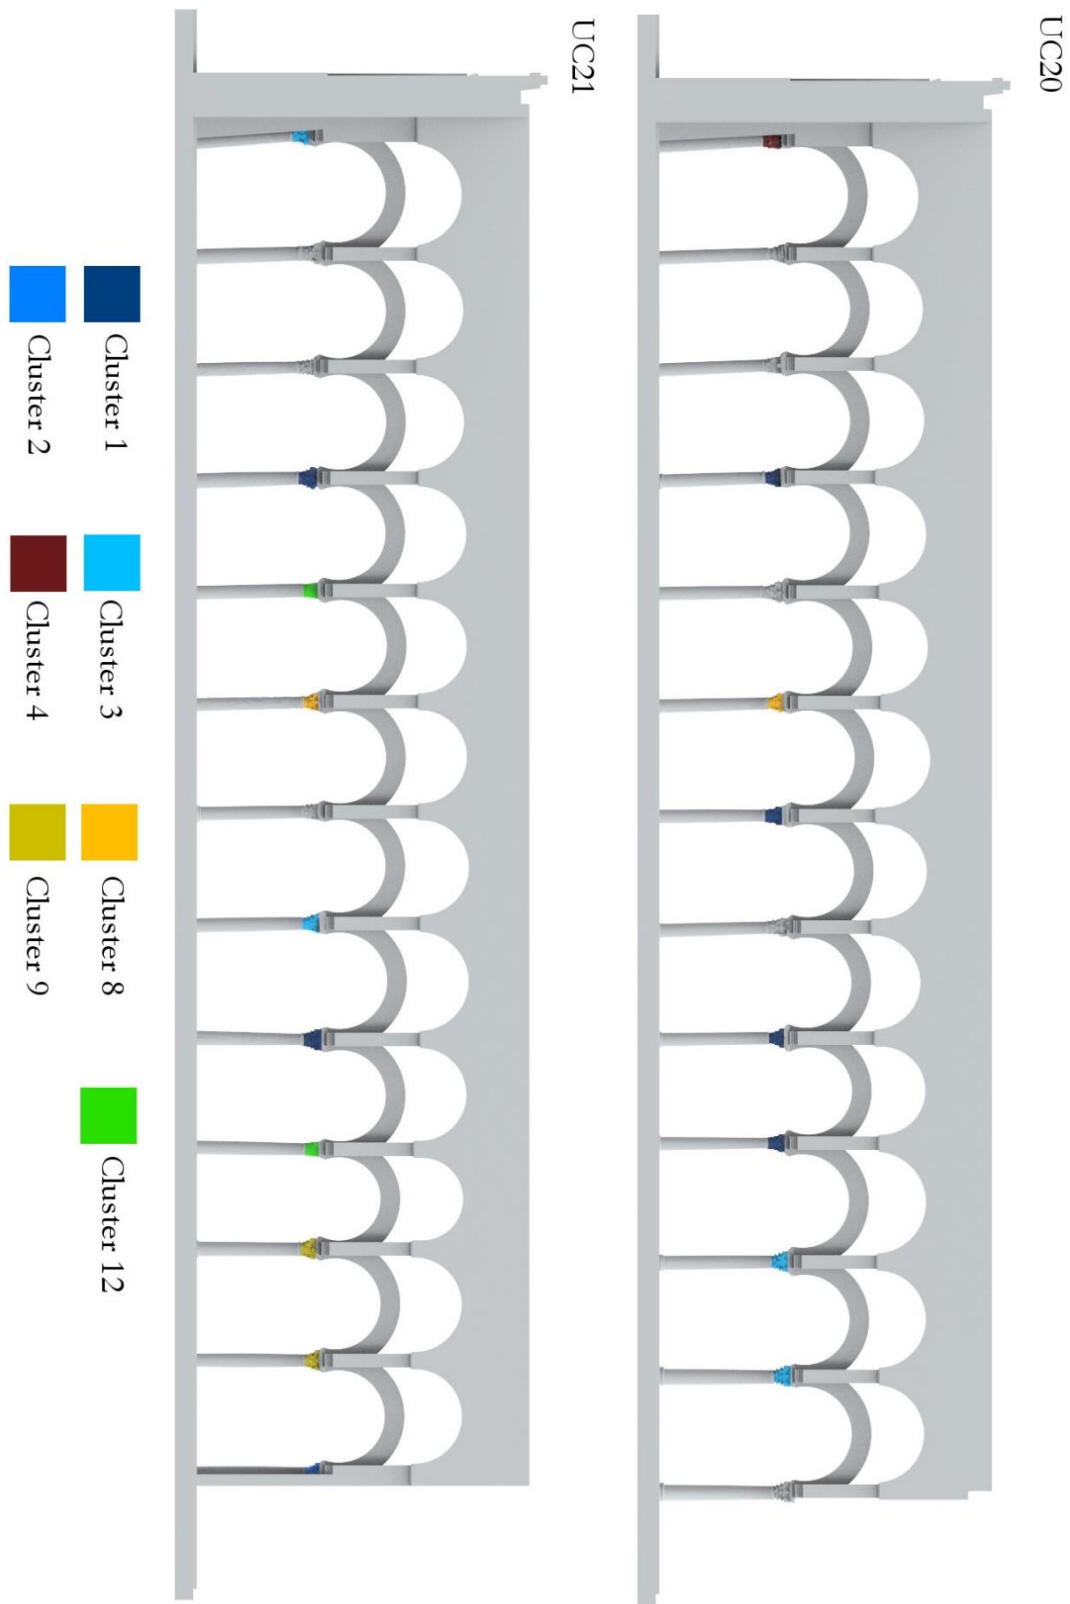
Alzado de las Unidades Constructivas (UC20-UC21) con los Clúster de los capiteles.
